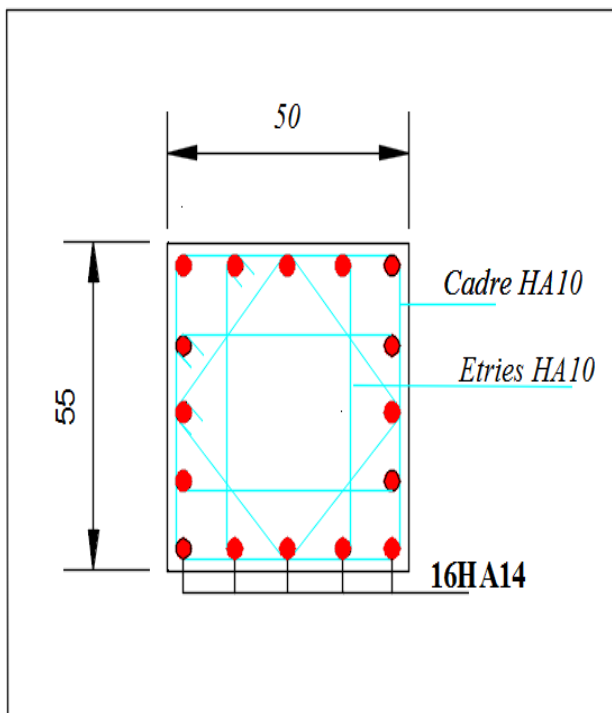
schéma de ferrailage des poteaux 6, 7^{ème} étages.
